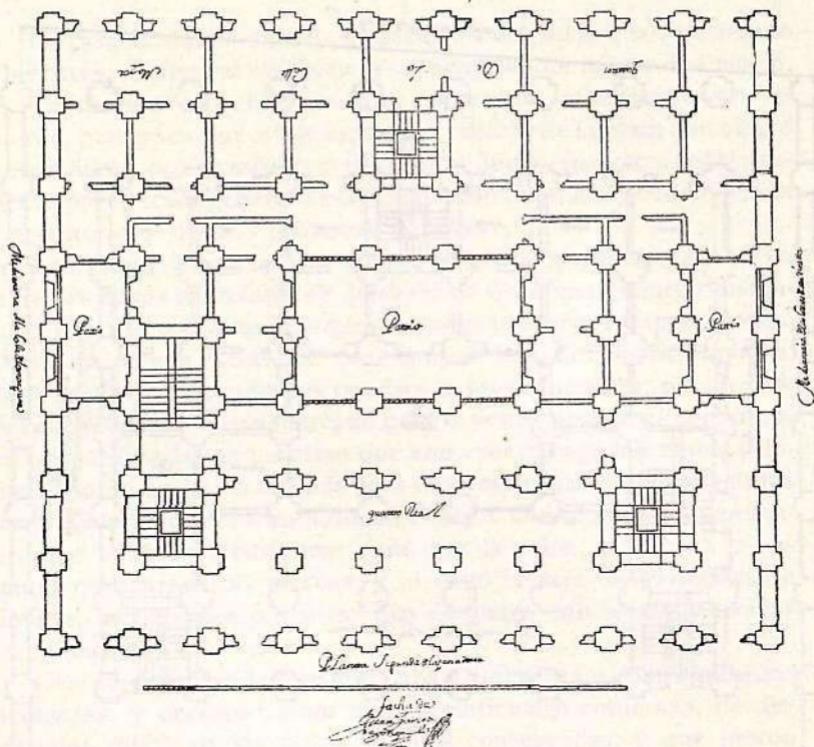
Planta principal del proyecto rechazado para reconstrucción de la Casa de la Panadería, firmado, como el anterior, por Juan García de Gonzalo.
